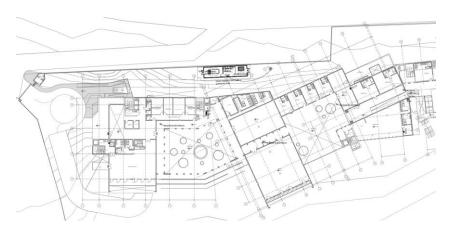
Plano de distribución redes generales primer piso Fuente: Elaboración propia.
